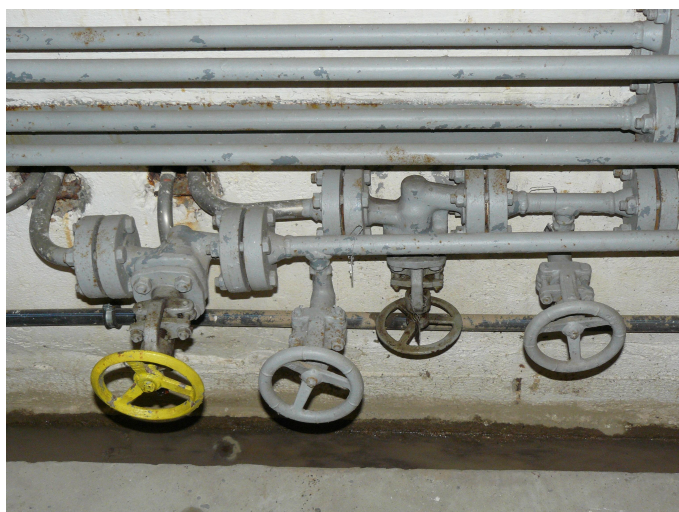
Stávající uzávěry na hydraulickém potrubí
